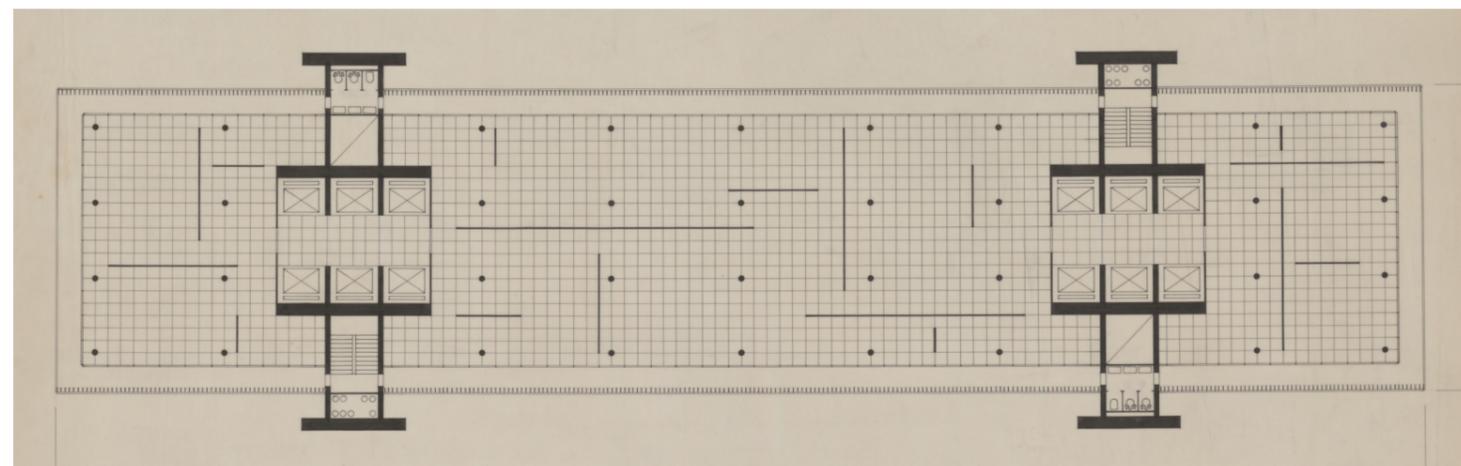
Bürogesschosse mit Raumkonzept (Grundriss), 1:100, 15.5.1961
